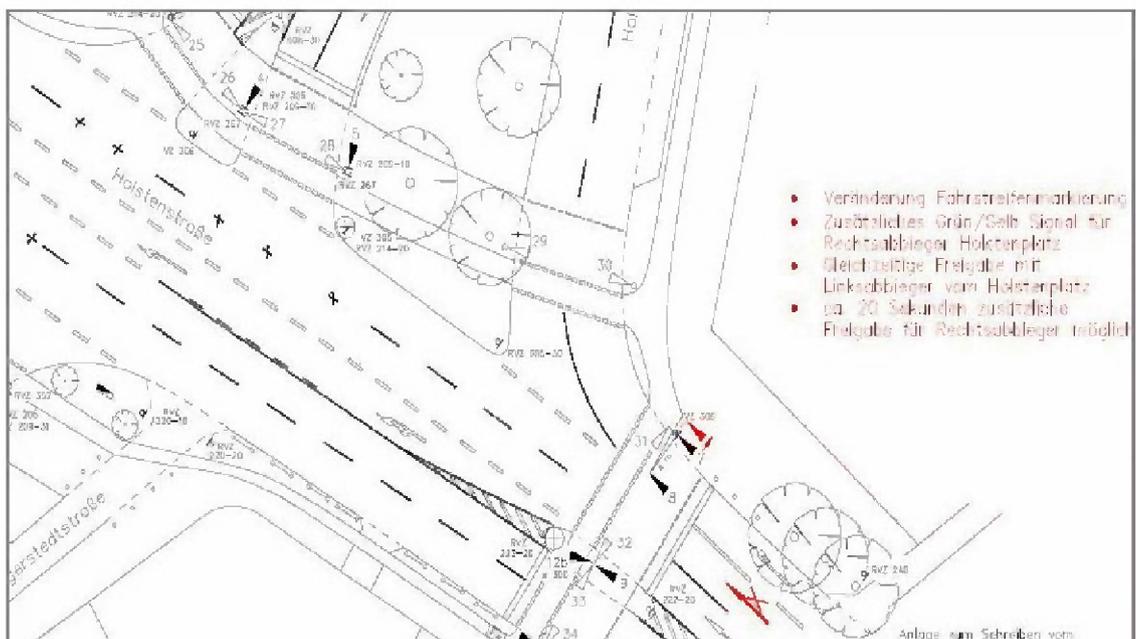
1 Lageplanentwurf LSA 600 mit geänderter Rechtsabbiegeföhrung
